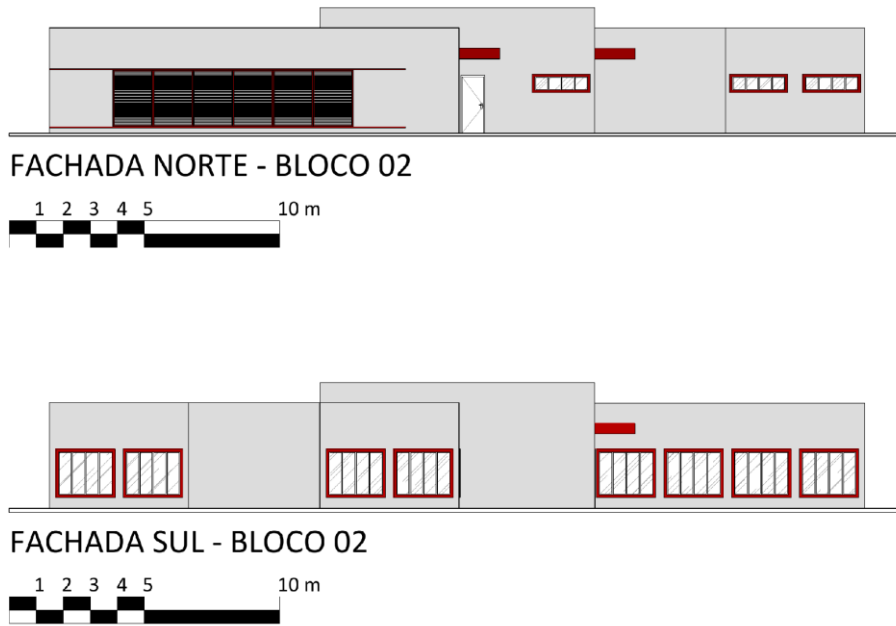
FACHADAS NORTE E SUL DO BLOCO 02. FONTE: AUTORAL.
